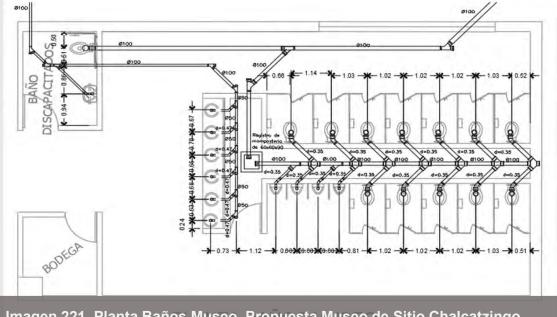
, Planta Baños Museo, Propuesta Museo de Sitio Chalcatzingo.
